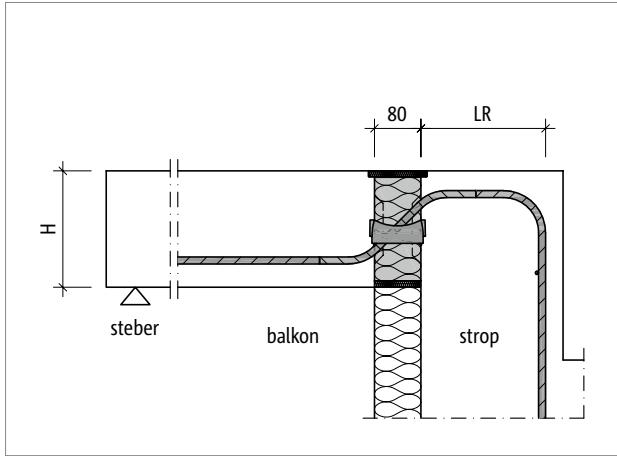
Schöck Isokorb® T tip QP-WU: stenski priključek navzdol pri zunanjji izolaciji
